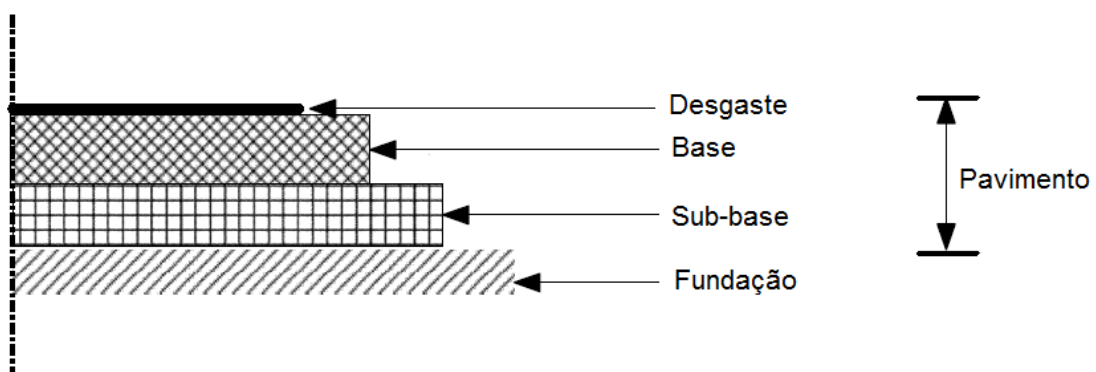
Constituição tipo de um pavimento para estradas de baixo tráfego. (adaptado de MTPW, 2013a)
